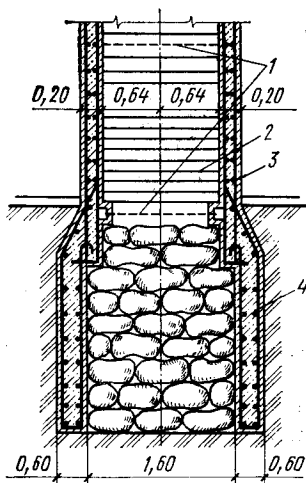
Усиление фундамента железобетонными обоймами: 1 — анкеры; 2 — стена подвала; 3, 4 — железобетонная обойма
